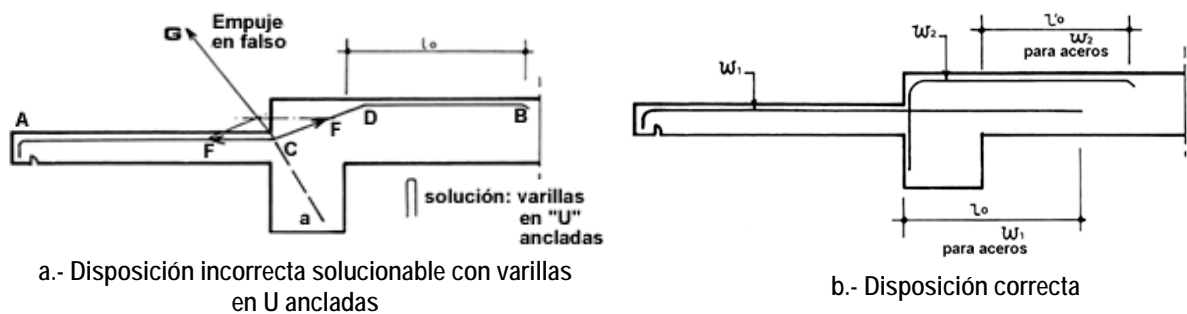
A – ACERO DE LOSA EN CANTILIVER trabajando a tensión en un cambio de nivel al realizar un balcón – Caso de losa maciza de concreto armado
